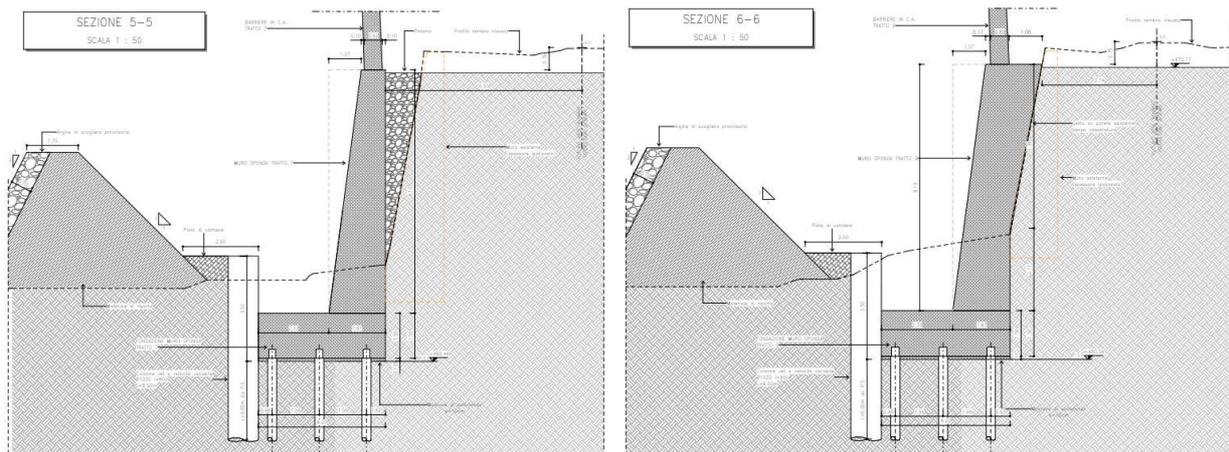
Sezioni tipologiche di progetto dell'argine di protezione e di servizio nella "zona muro 1".
